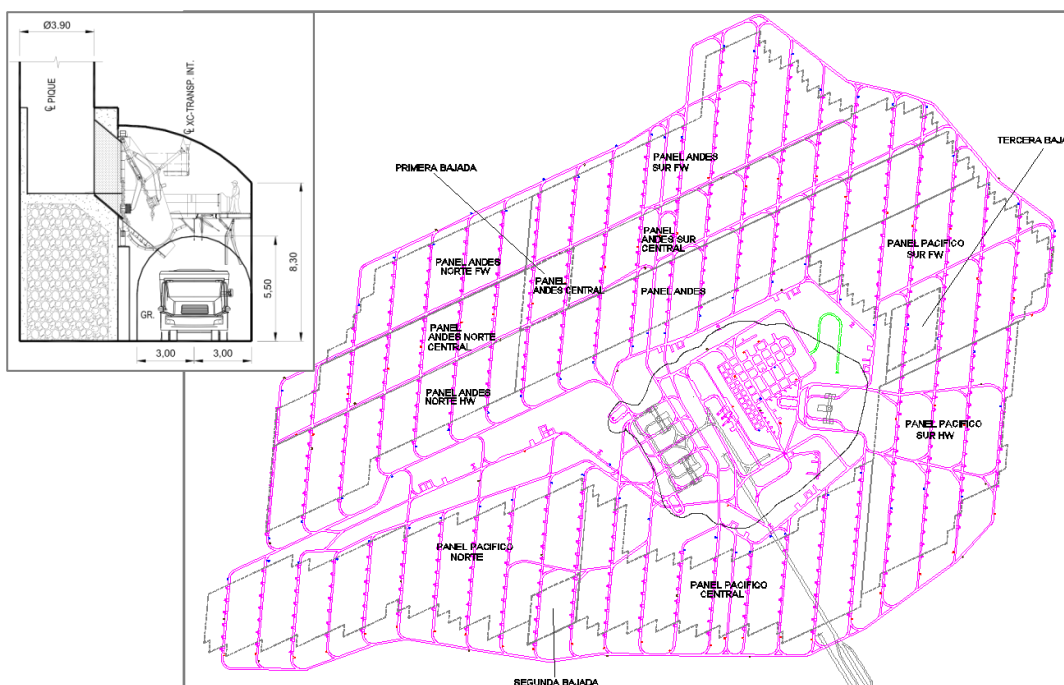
Layout Nivel Transporte Intermedio.
